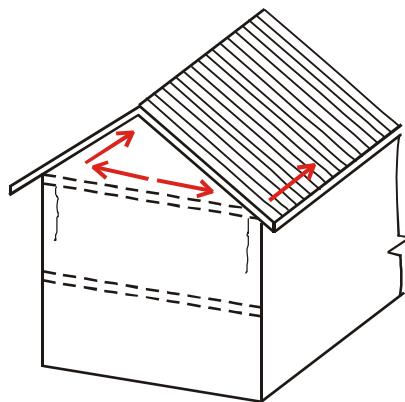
fissuras verticais em parede de alvenaria por retração da laje (DUARTE, 1998)
